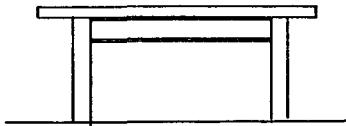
LOSA DE CONCRETO SOBRE VIGAS "I" DE ACERO.
